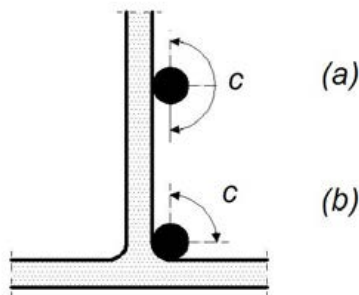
Ефективний периметр з арматурного стержня
